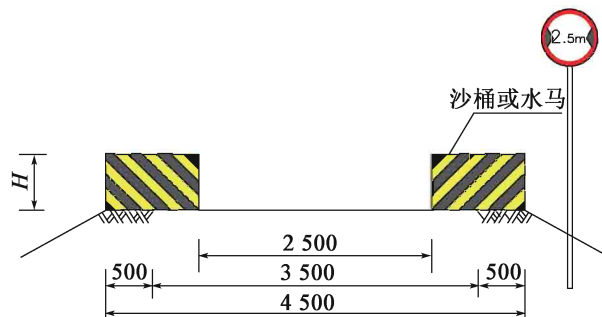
限宽墩结构示意(尺寸单位: mm)
